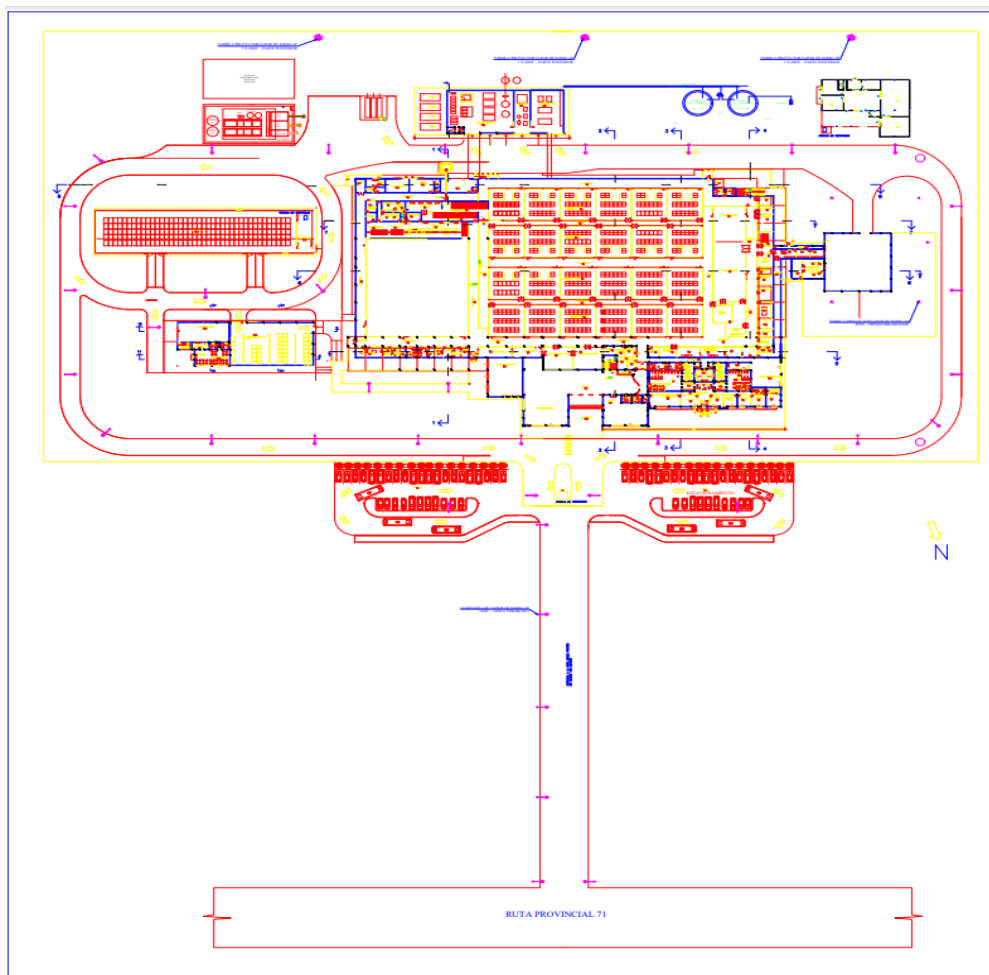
Esquema general de la Bioplanta Santa Rosa
